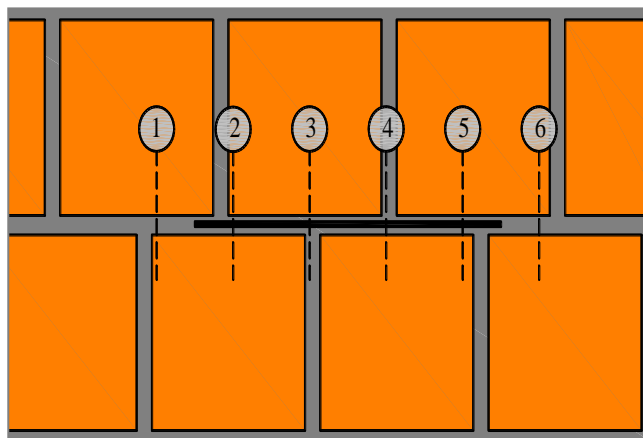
Ensaio A: vista longitudinal da posição do macaco plano, das miras de leitura e das juntas horizontais e verticais
